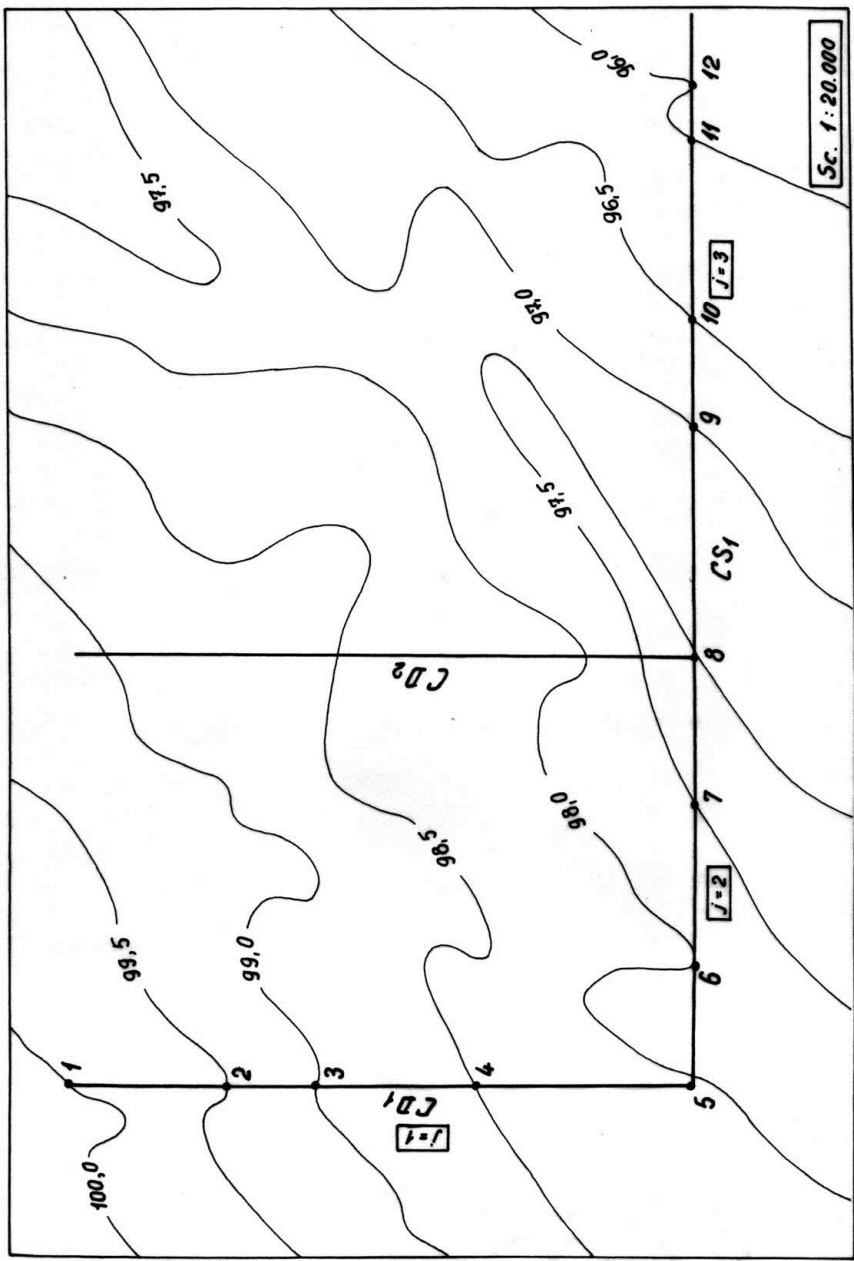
Plan de situație cu traseul în plan al rețelei de canale
